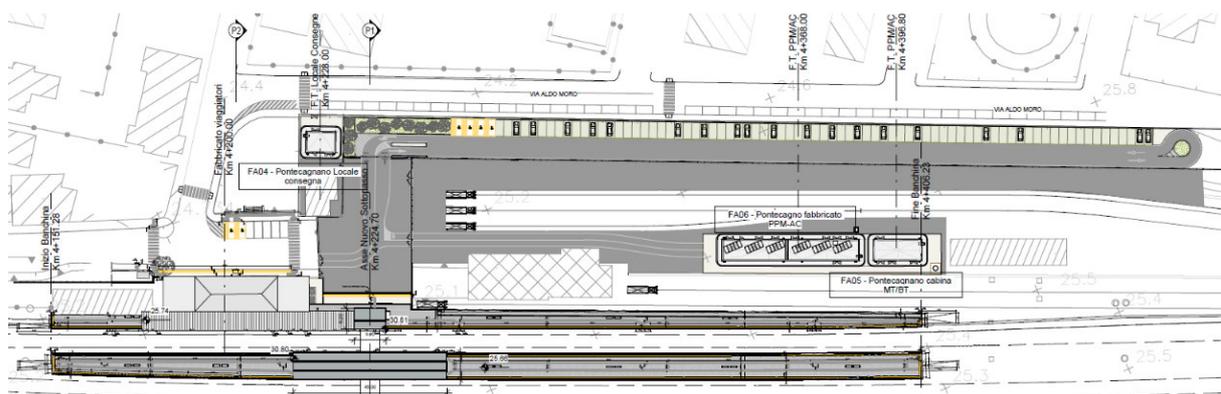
Planimetria Generale Pontecagnano alla fine del lotto 1.0
